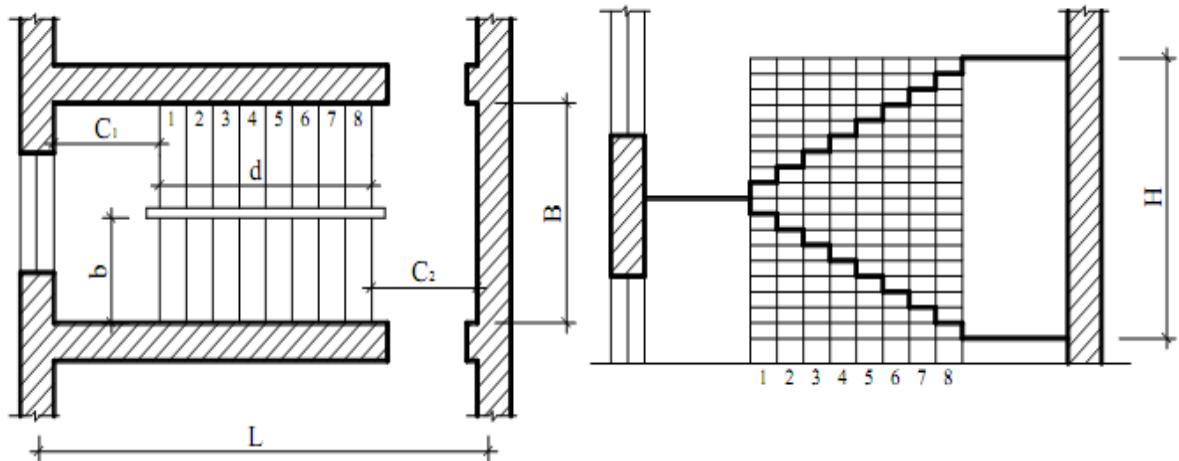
Побудова двомаршової сходової клітки житлового будинку
